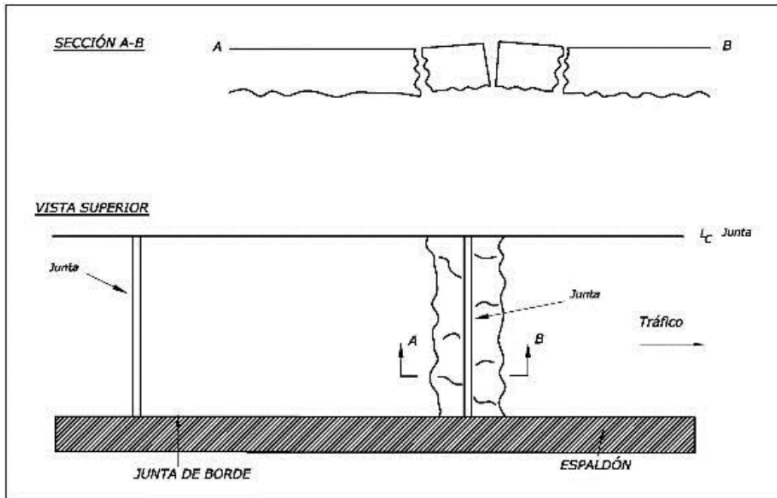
Esquema Voladuras - Pavimento Rígido
